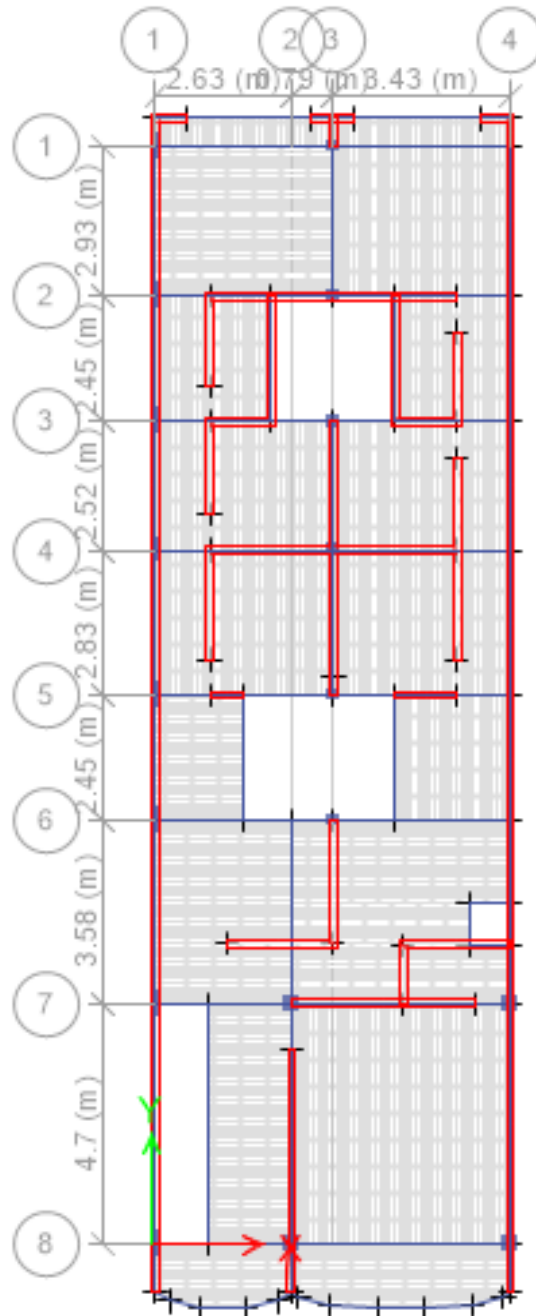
Esquema del edificio en planta (e=020cm) (ETABS 2016)
